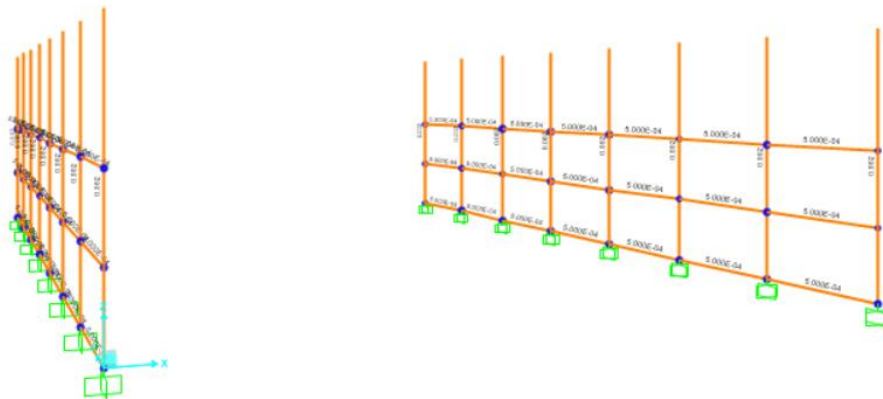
Verificación de secciones de hormigón armado en la nave industrial 1
